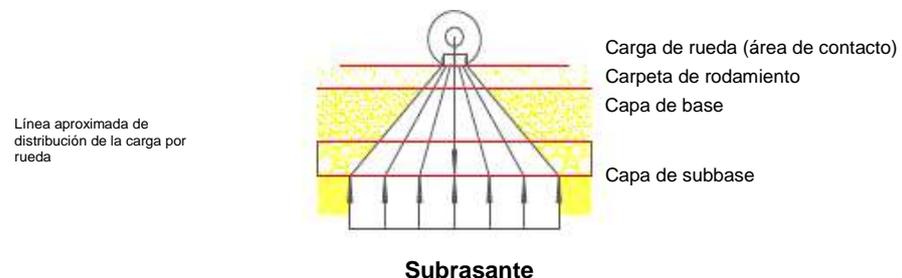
Distribución de carga de una rueda en el pavimento flexible
